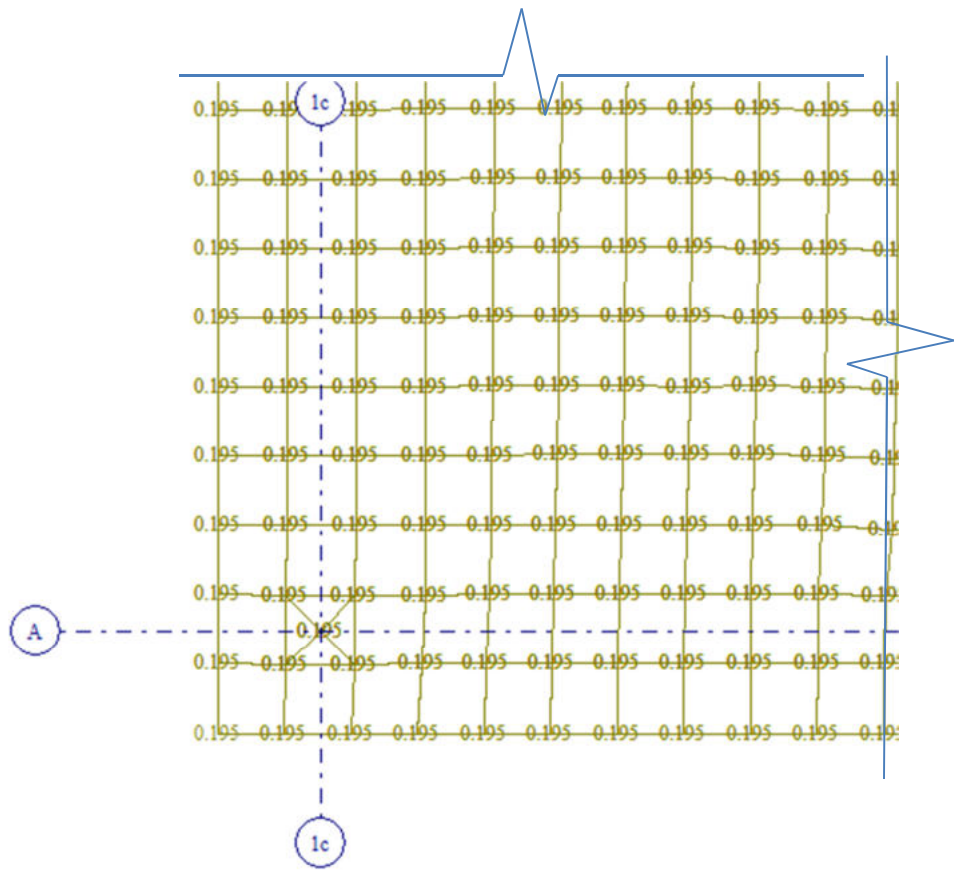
Фрагмент плиты с указанием нагрузок полезной нагрузки на перекрытие
